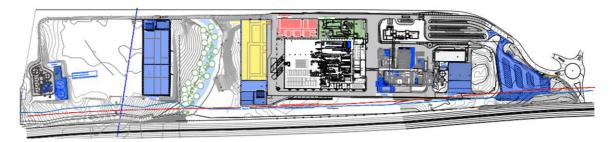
Planta com intervenções que constituem o projeto a azul.
